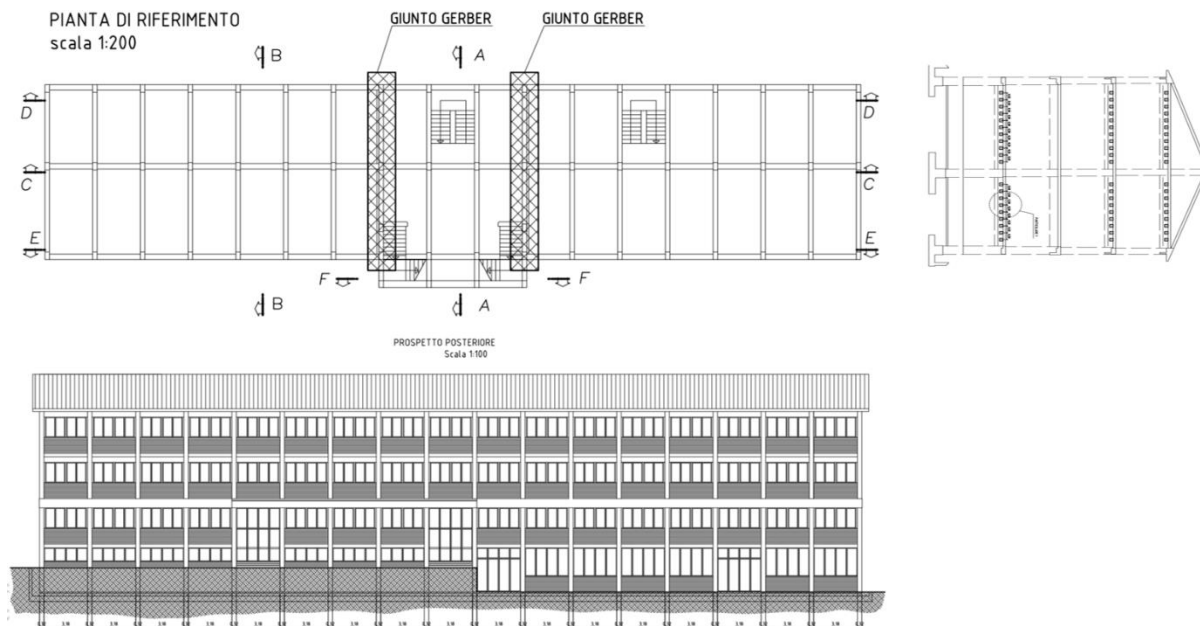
Edificio pre-intervento: pianta strutturale, sezione trasversale e prospetto longitudinale.
